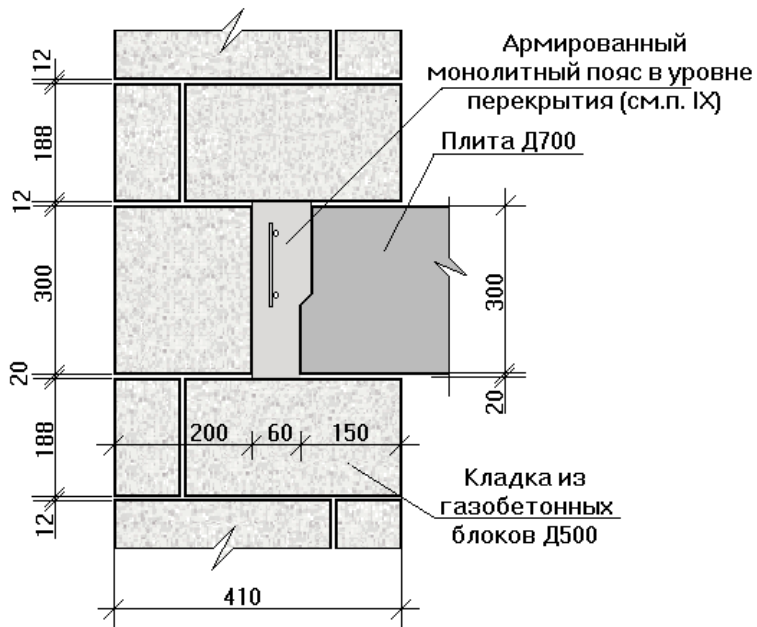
Пример опирания плиты перекрытия из газобетона на стену толщиной 410мм.
